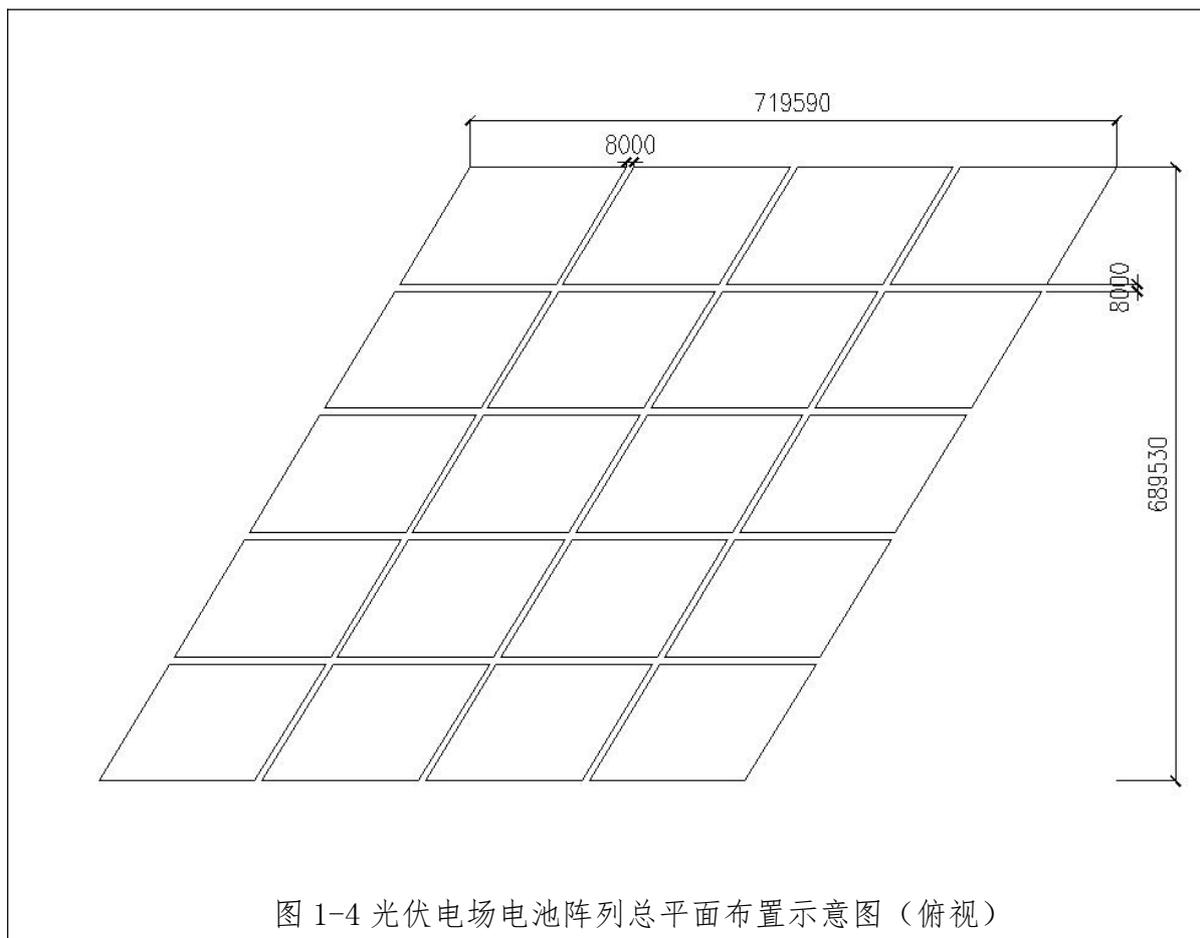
光伏电场电池阵列总平面布置示意图（俯视）
